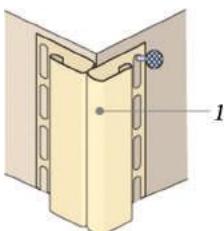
Облицовка угла стены двумя J-профилями (1)
